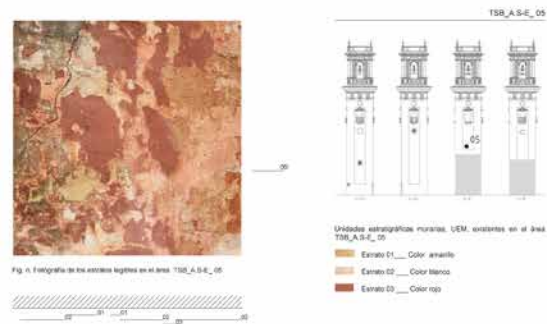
Sección horizontal esquemática TSB\_A\_S-E\_05
